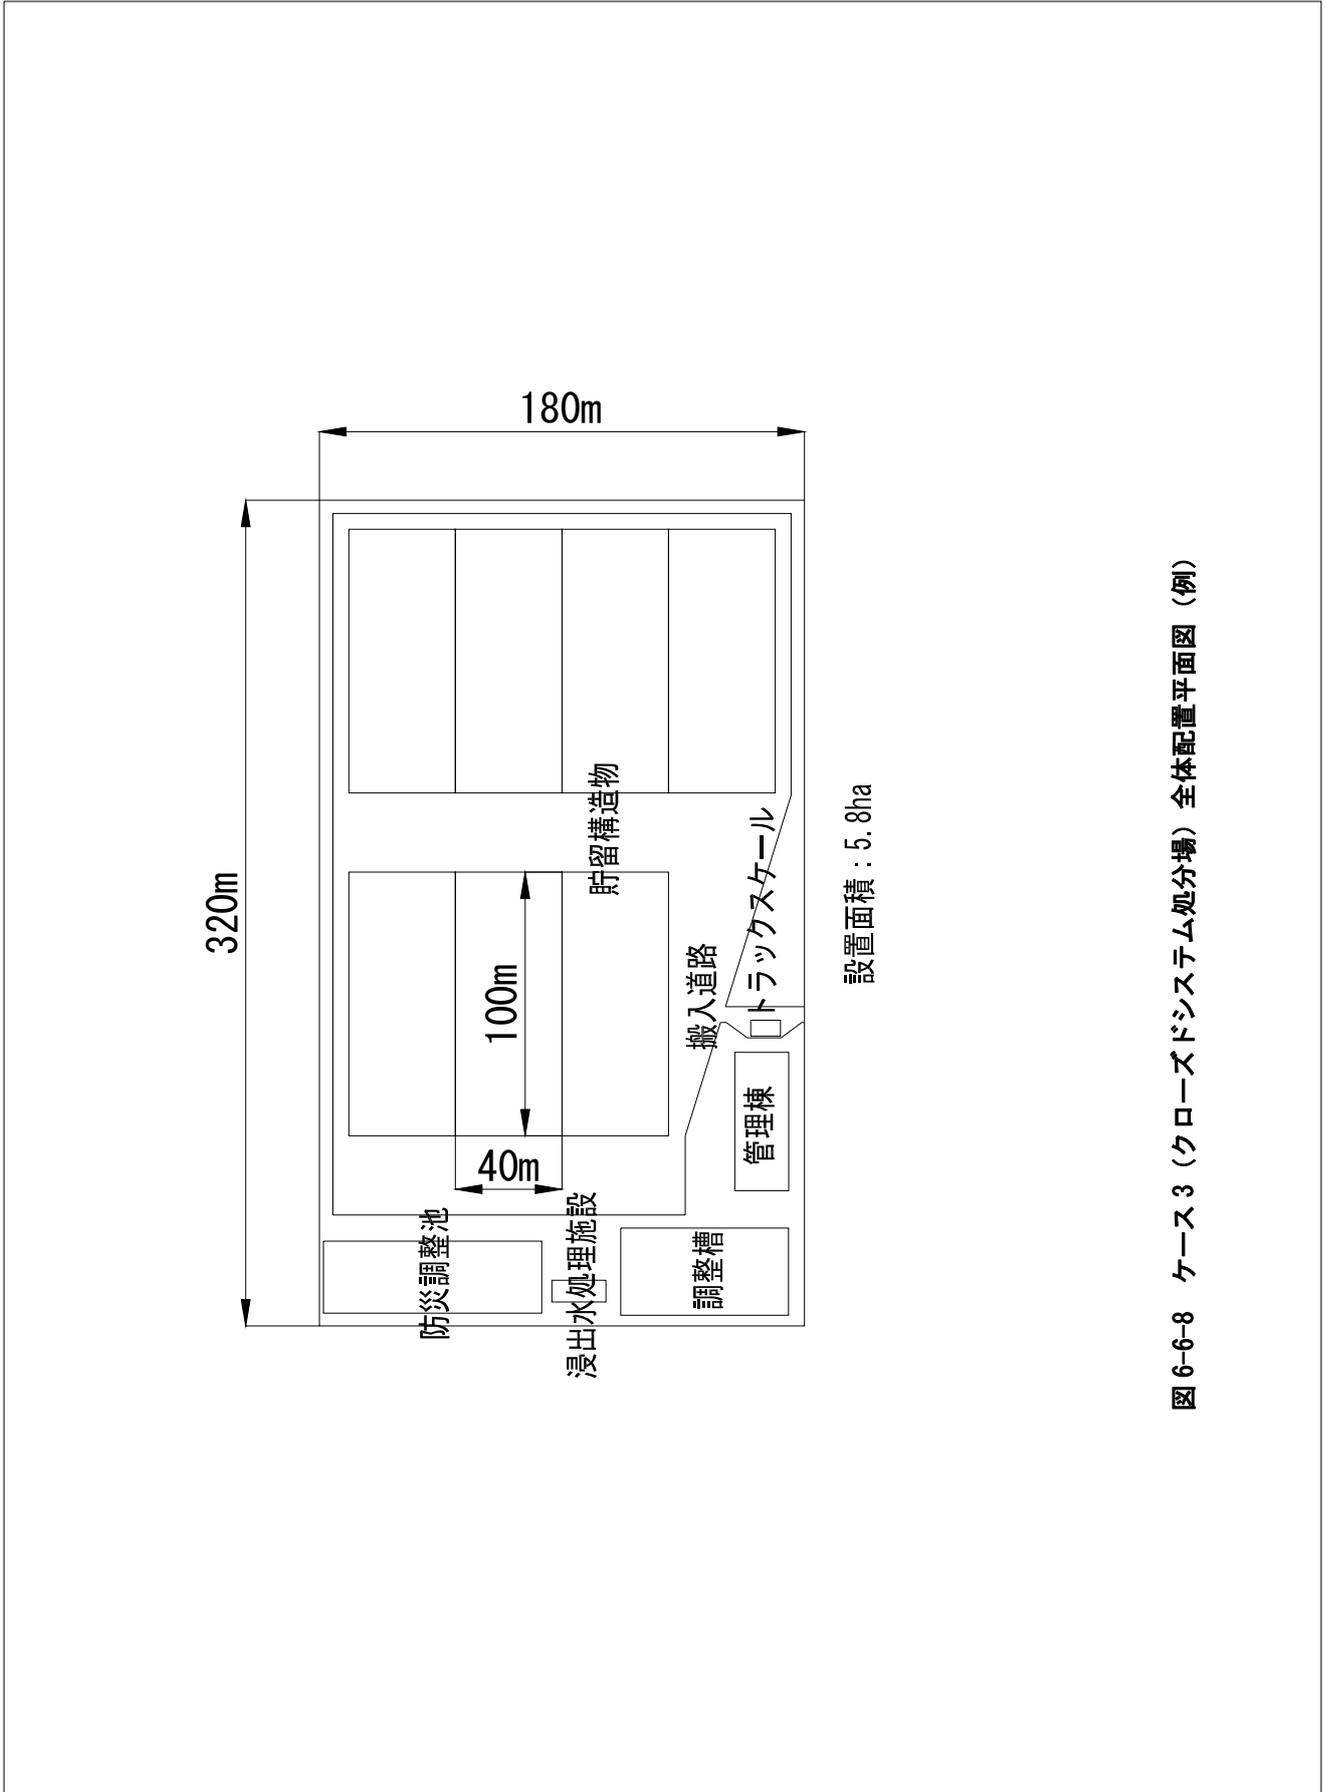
ケース 3 (クロージドシステム処分場) 全体配置平面図 (例)
